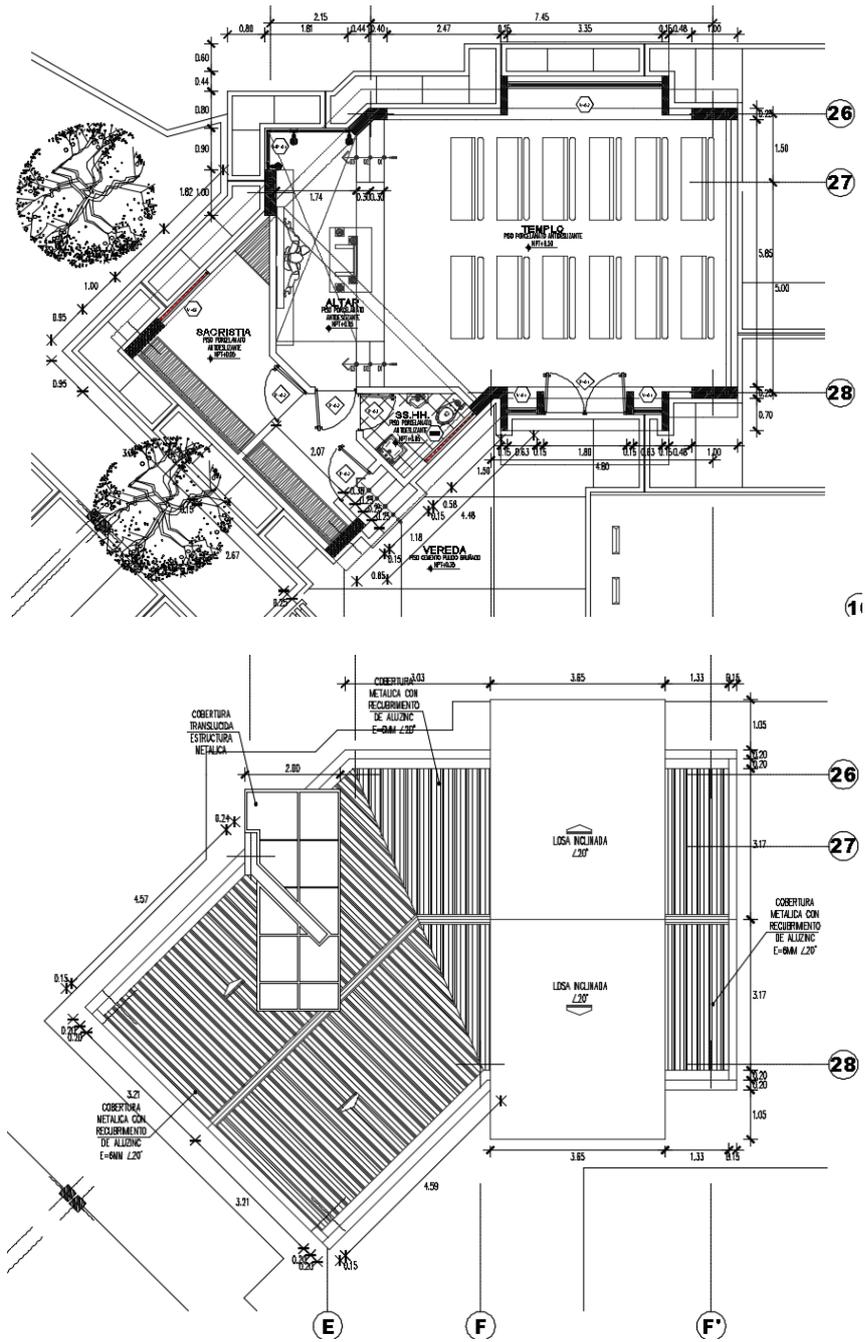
Propuesta Arquitectónica Bloque M, 1°, Techos
